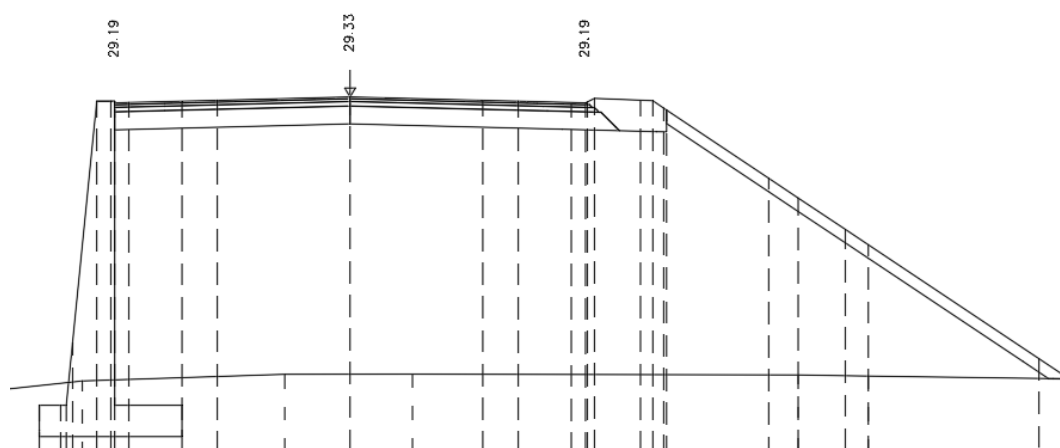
Sezione A1 del rilevato di approccio alla spalla A, tra pk 0+185 e pk 0+135
